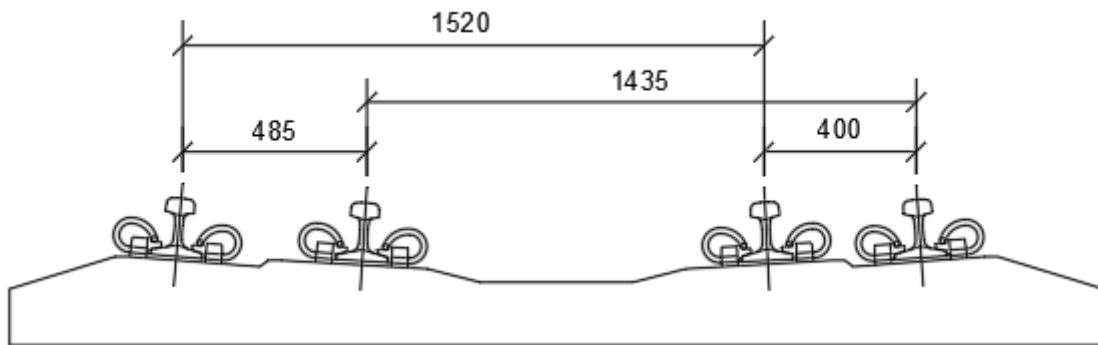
Схематичне зображення поперечного перерізу суміщеної колії на залізобетонних шпалах, скріплення КПП-5
